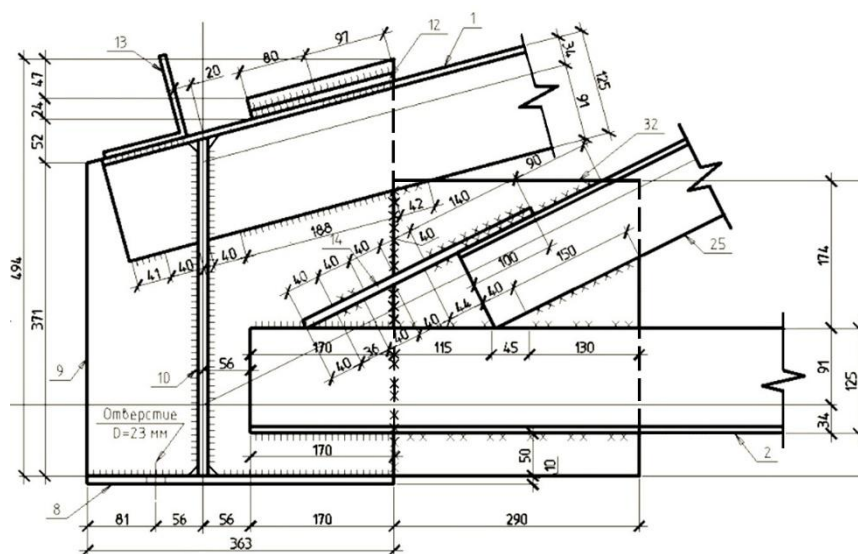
Конструкция опорного узла фермы, разработанная в проекте [8]
